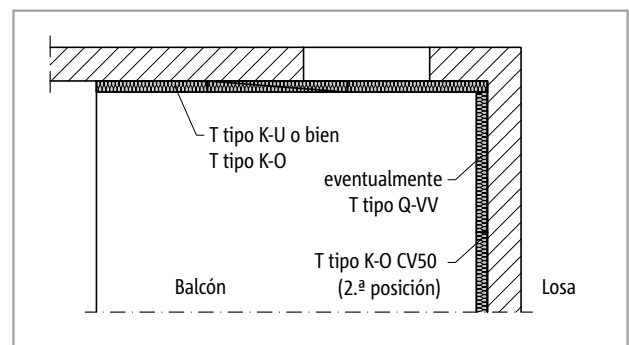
Schöck Isokorb® T tipo K-U o bien T tipo K-O, T tipo Q-VV: Balcón en esquina interna, apoyado sobre dos laterales
